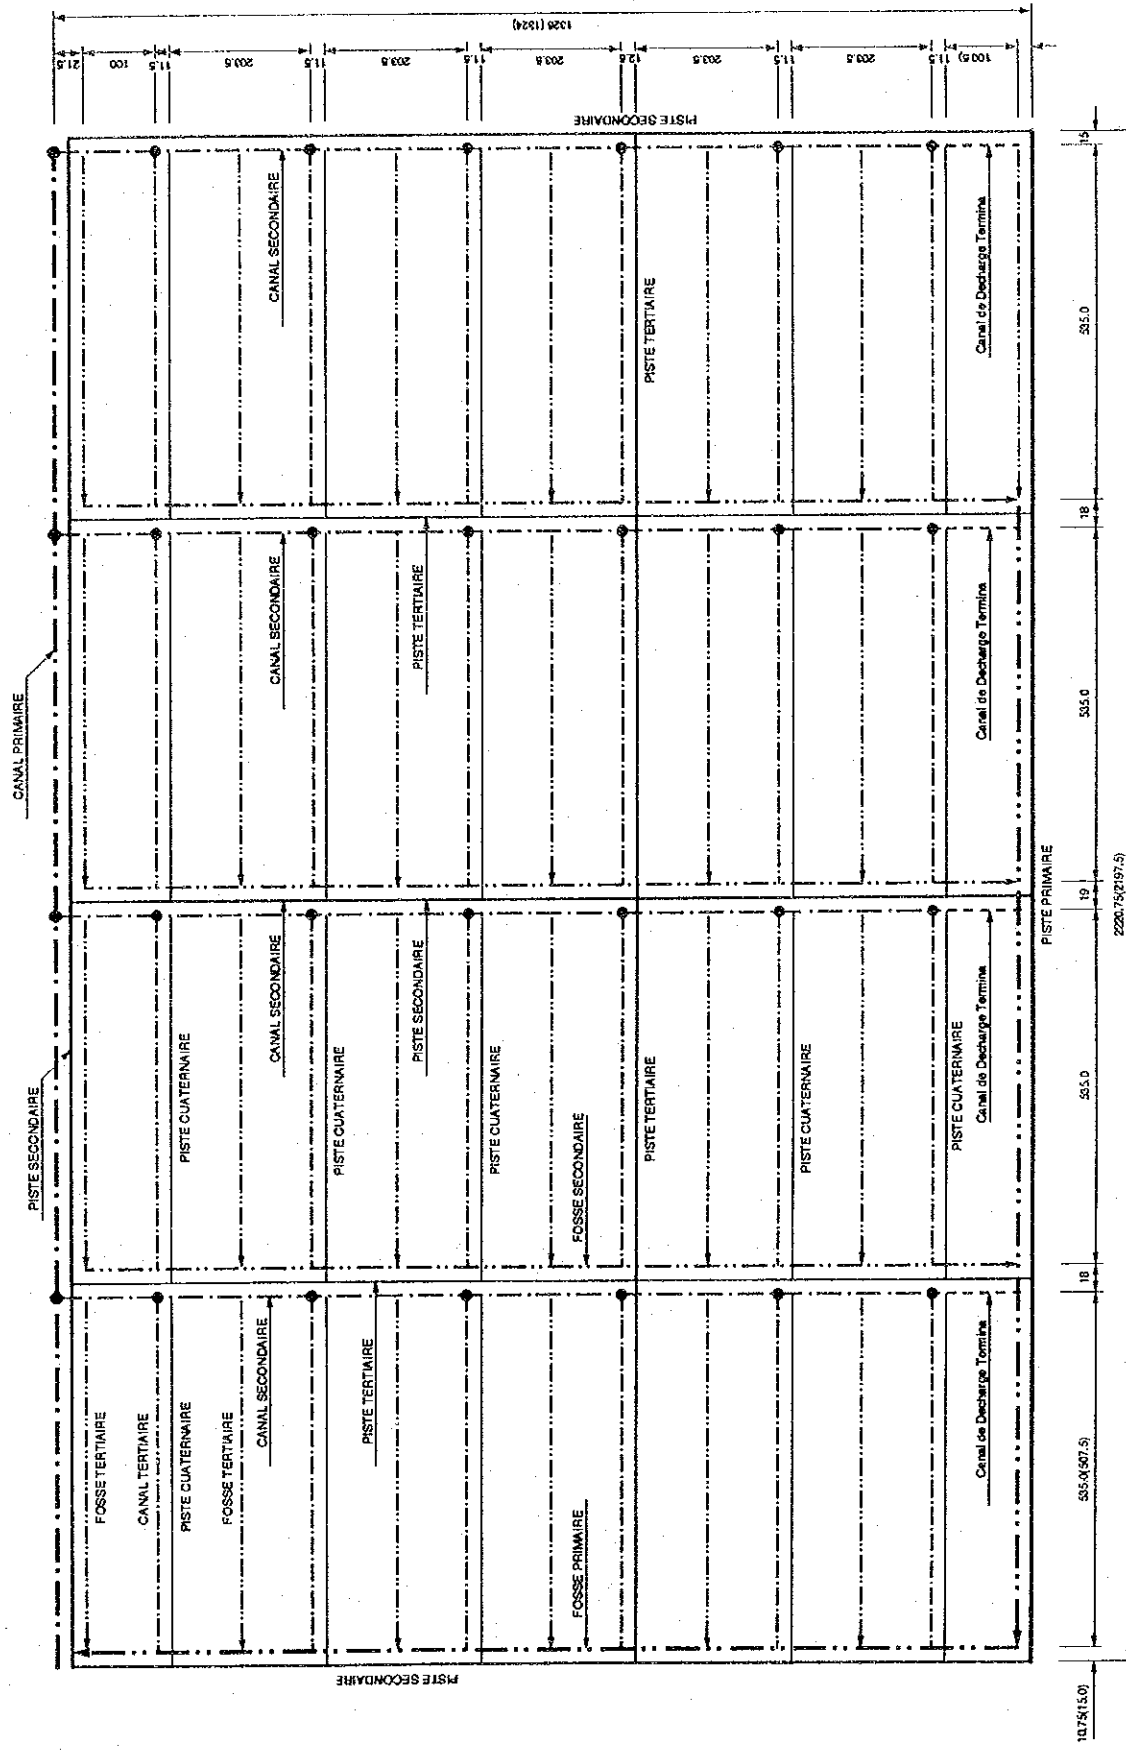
LE PLAN DE LA DISPOSITION DES PERIMETRE
